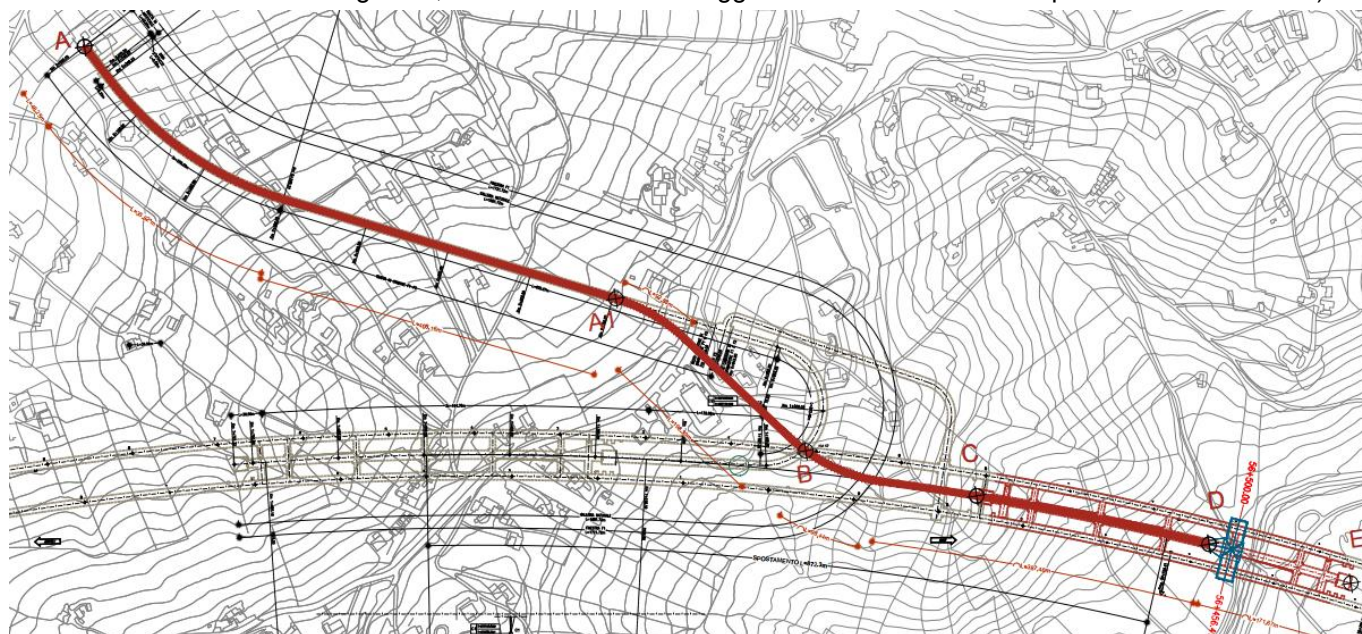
Andamento planimetrico Finestra F1 (in nero soluzione di PD e in rosso soluzione ottimizzata)
